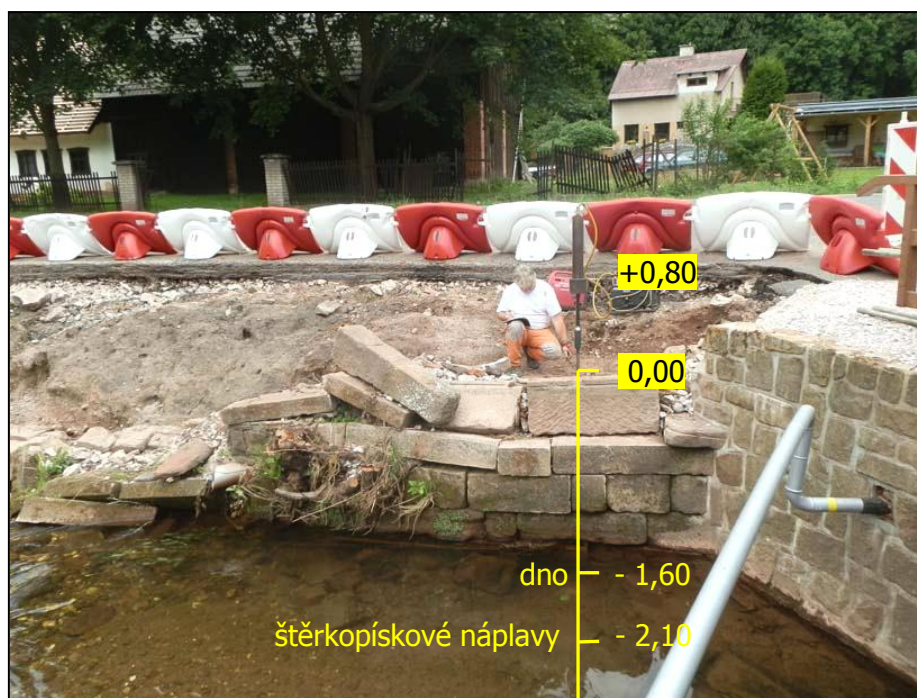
jádrová a penetrační sonda za rozbořenou břehovou zdí
